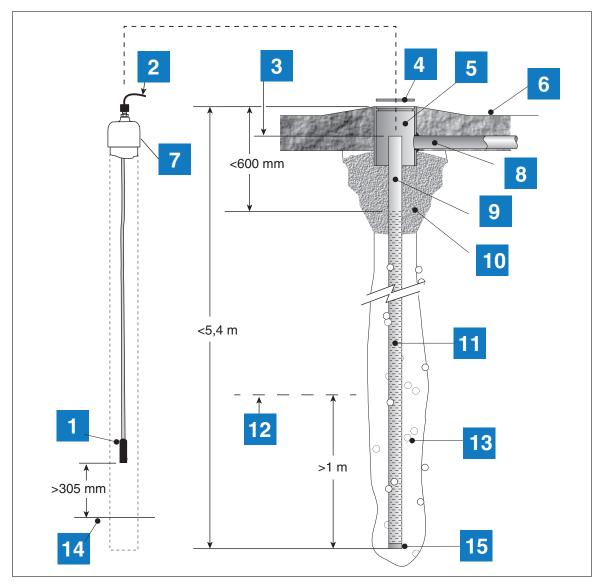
Section transversale au travers d'un exemple d'installation de capteur de vapeur
